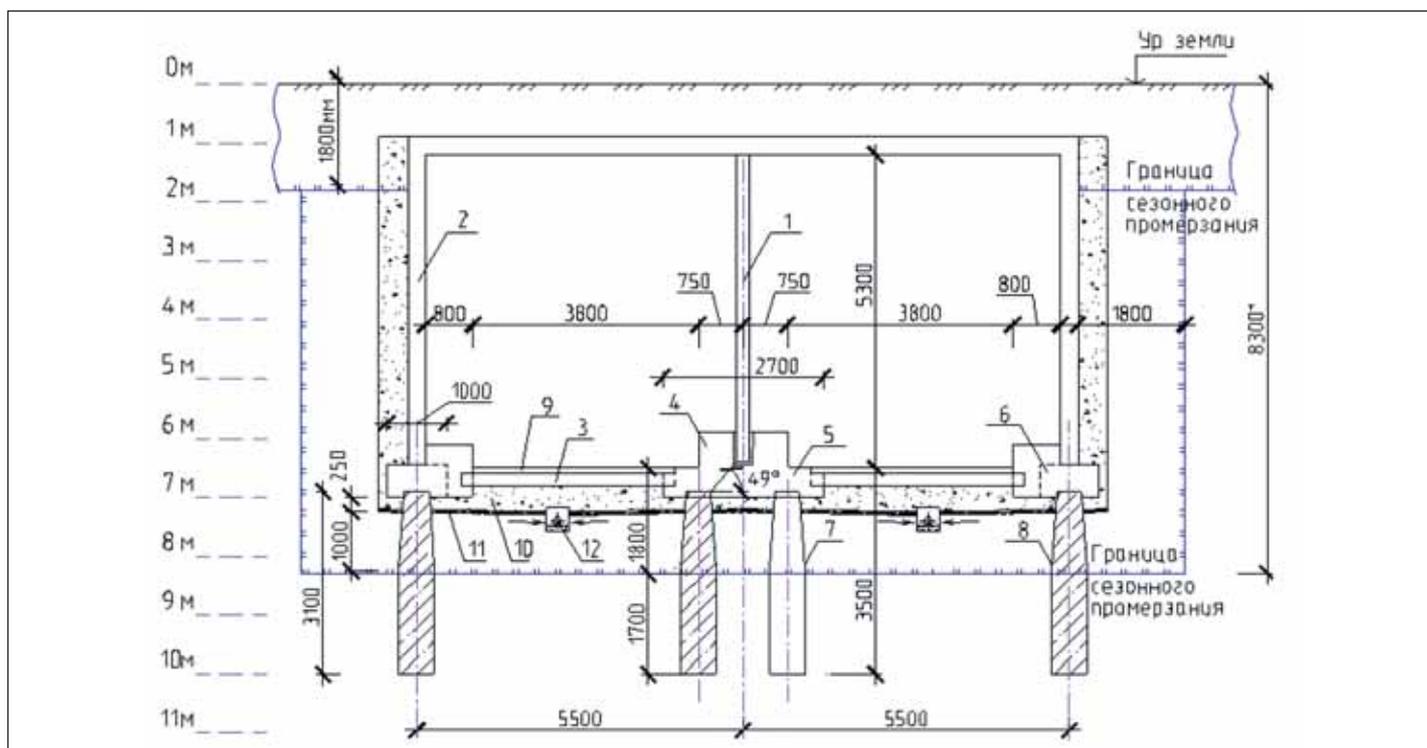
Конструктивная схема тоннеля мелкого заложения: 1 – колонна; 2 – стена тоннеля; 3 – дорожные плиты; 4 – разделительная полоса; 5 – свайный ростверк среднего ряда; 6 – свайный ростверк крайнего ряда; 7 – свая среднего ряда; 8 – свая крайнего ряда; 9 – дорожное покрытие; 10 – подсыпка из песчано-гравийной смеси; 11 – георешетка; 12 – дренажная труба
